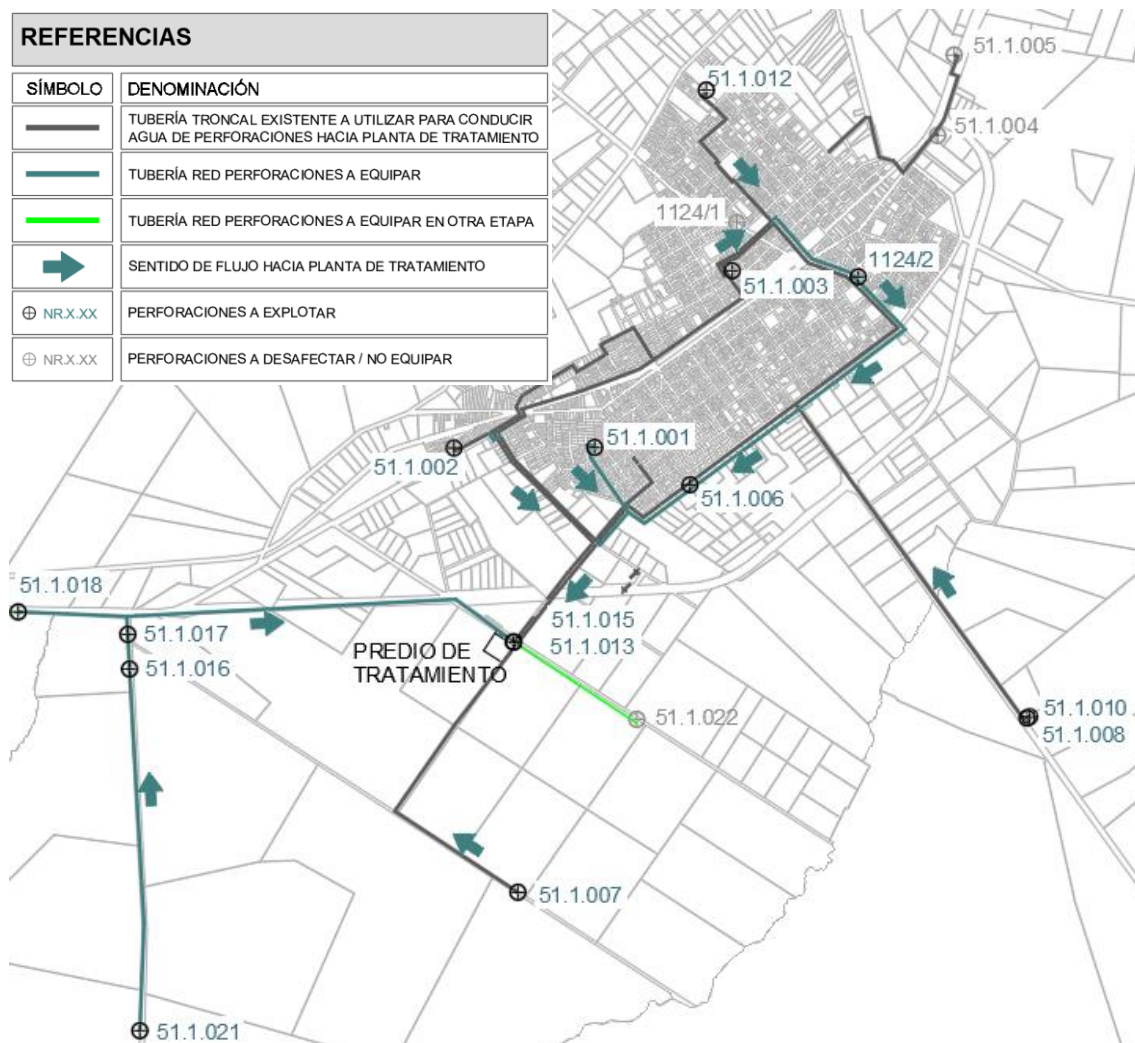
Perforaciones a equipar y redes de aducción a planta de tratamiento
